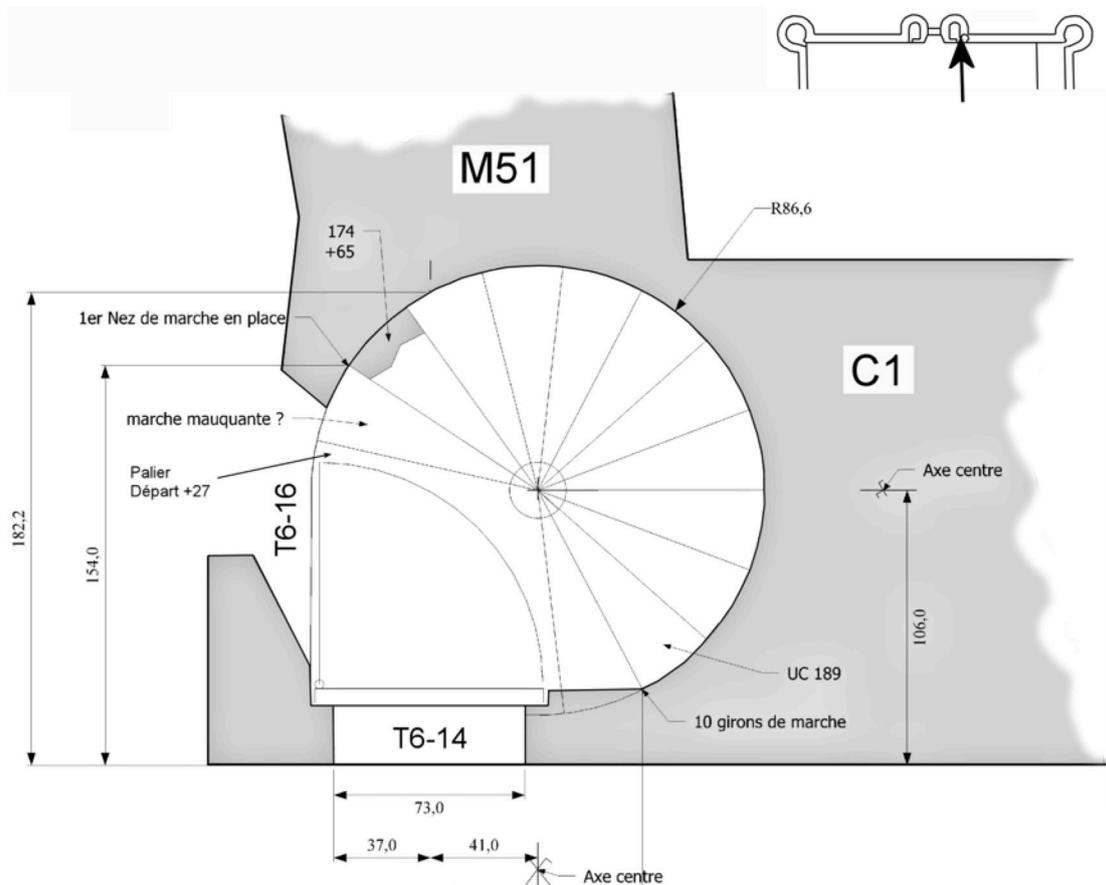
Tour T6 - Niveau 1 - Plan de l'escalier en vis ST18 (DAO : Michel Piechaczyk/ ADM)
